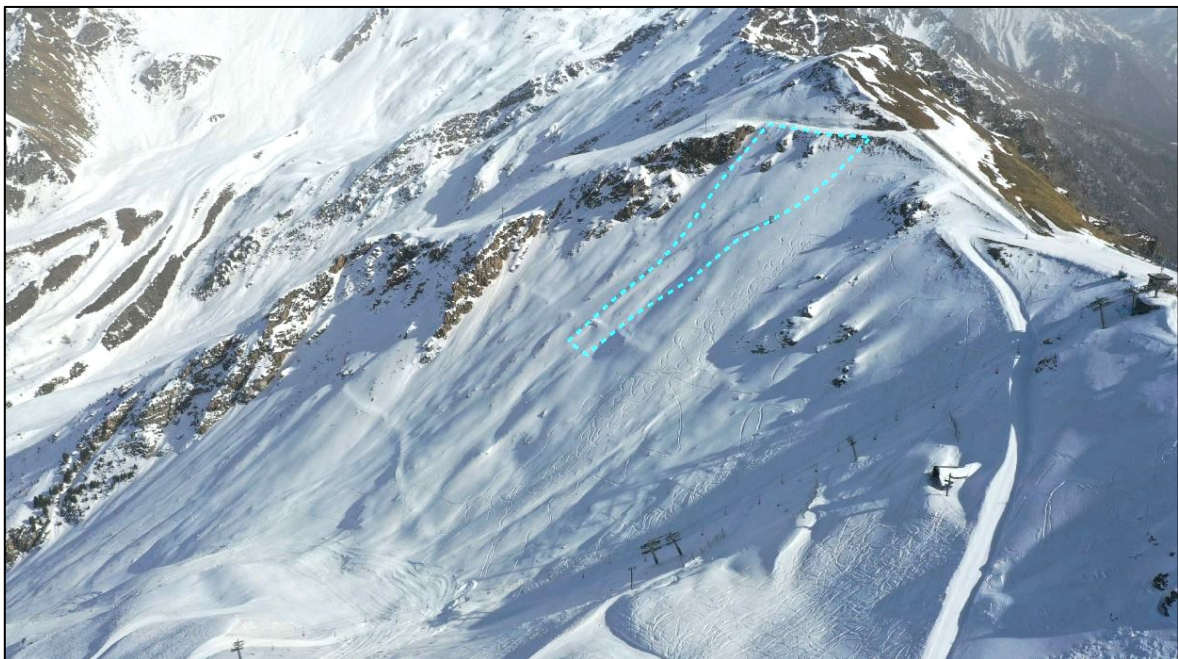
INDIVIDUAZIONE AREA IMPIANTO PARAVALANGHE
